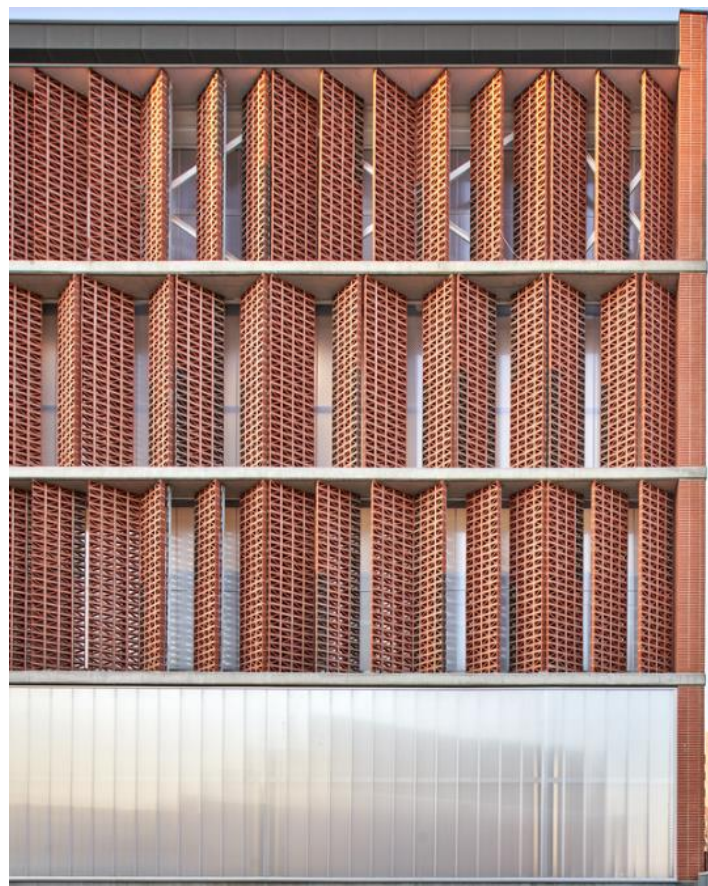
Фасад будівлі з поворотними елементами [1]
